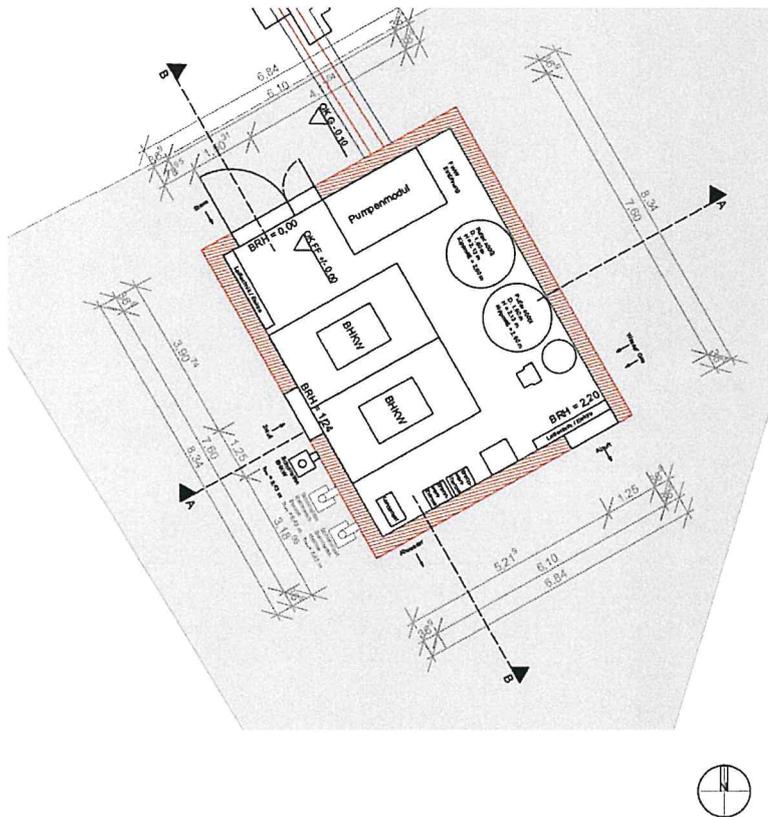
Aufstellungsplan und Grundriss für die Heizzentrale (Auszug aus Grundriss aus Bauantrag)
